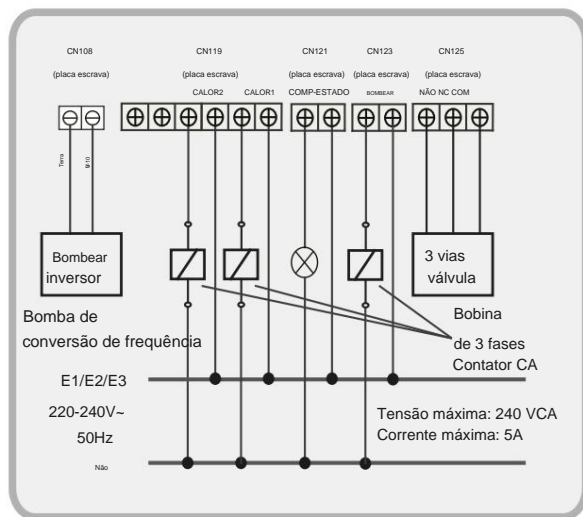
Fiação do aquecedor auxiliar de tubulação e luz CA do estado do compressor (65 kW, 75 kW, 110 kW e 140 kW)
